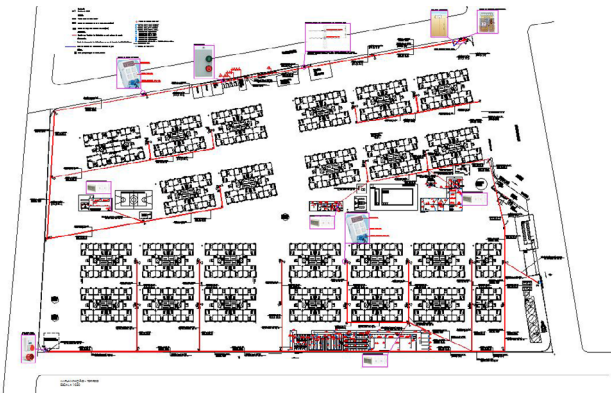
Planta baixa de localização e de distribuição de energia de um canteiro de obras.
